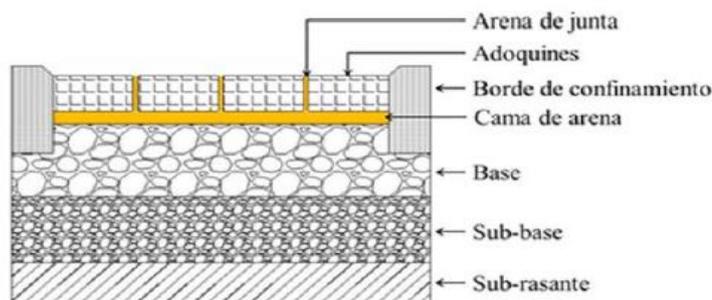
Elementos estructurales de un pavimento de adoquín de concreto (ASCE,2010)
